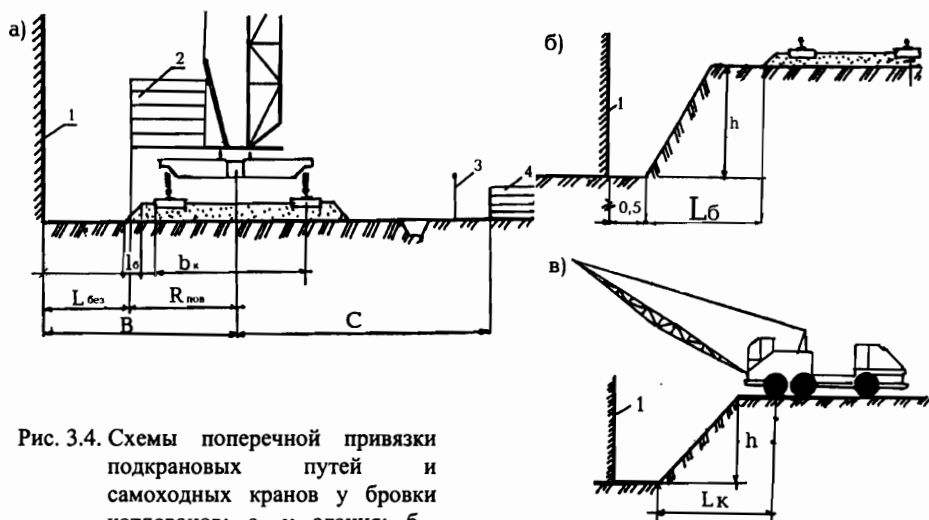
Схемы поперечной привязки подкрановых путей и самоходных кранов у бровки котлованов: а – у здания; б – вблизи котлованов или траншей; в – пневмоколесного крана у котлована. 1 – строящееся здания; 2 – противовес башенного крана; 3 – ограждение; 4 – складирование сборных конструкций
